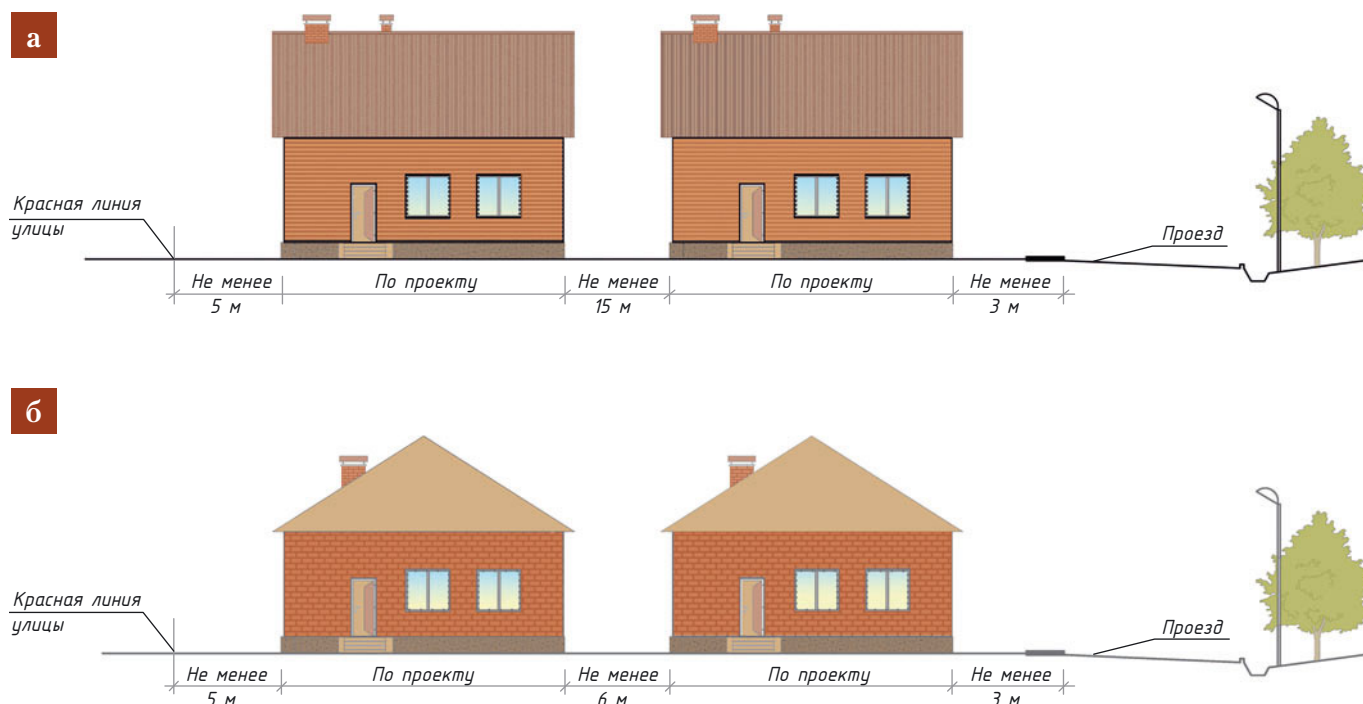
Нормативные расстояния между домами, красными линиями, проездами: а — дома с деревянными стенами; б — дома с каменными стенами и монолитными перекрытиями
